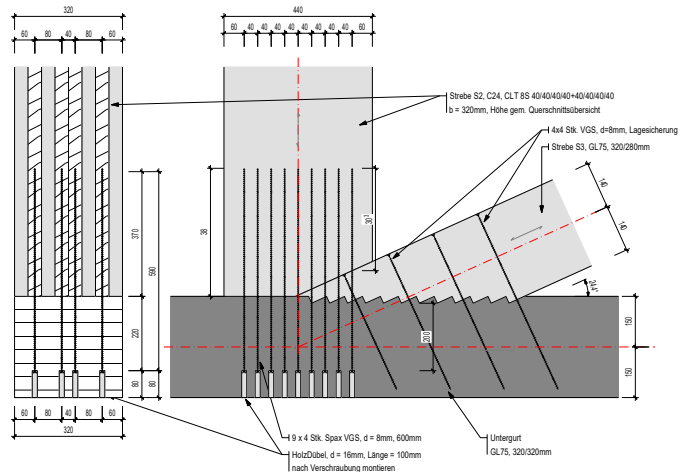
Anschluss-Detail Fachwerk-Knoten mit bis zu 59 cm langen Schrauben und Holzdübeln zum Verstößeln. (Zeichnung: Holzbau Amann)
